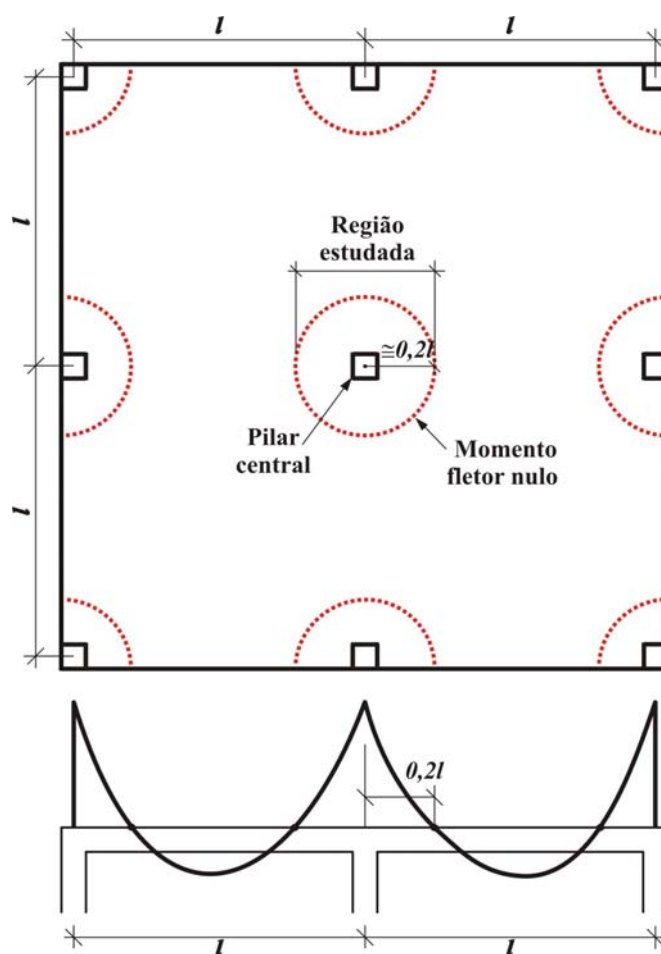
Estrutura hipotética em planta e corte caracterizando a situação estudada
